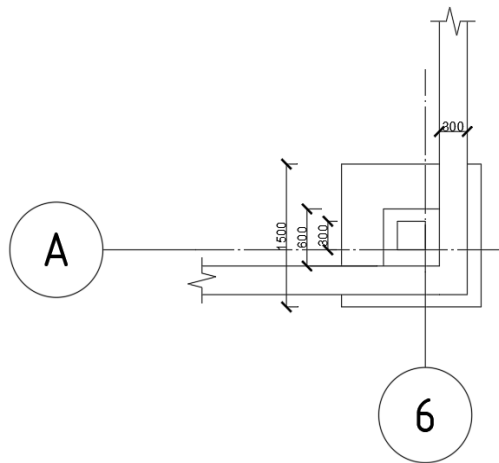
Схема столбчатого фундамента Ф-1, вид сверху
